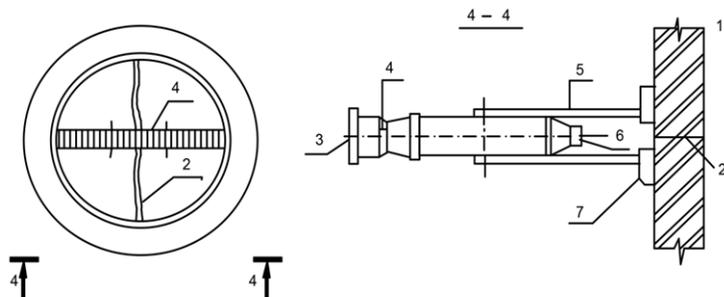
Отсчетный микроскоп МПБ-2: 1 – строительная конструкция; 2 – трещина; 3 – окуляр; 4 – шкала; 5 – штатив; 6 – лупа; 7 – основание
